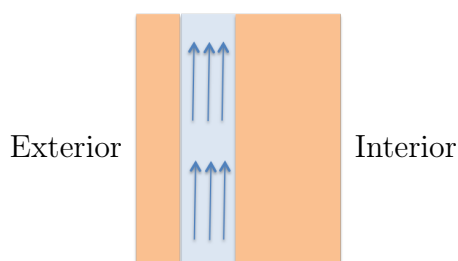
Esquema de fachada compuesta por: Elemento exterior masivo, muro interior masivo.
